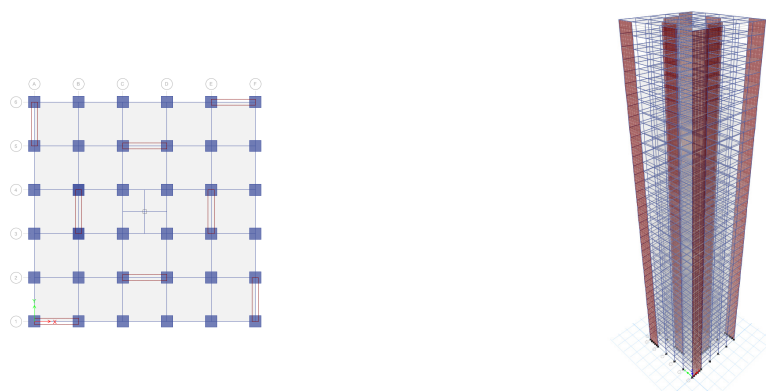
Structura duala din b.a. avand forma patrata - plan si elevatie
